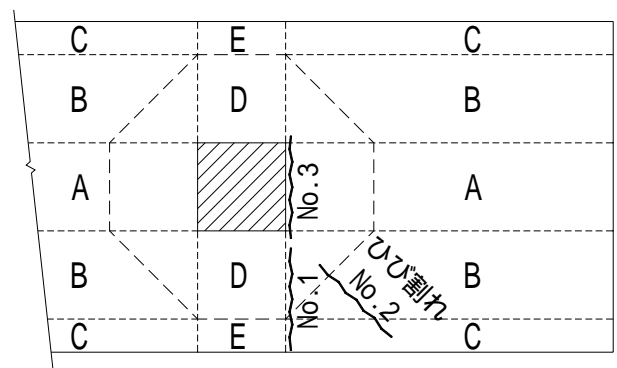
スラブのエリア分け, ひび割れ位置図
